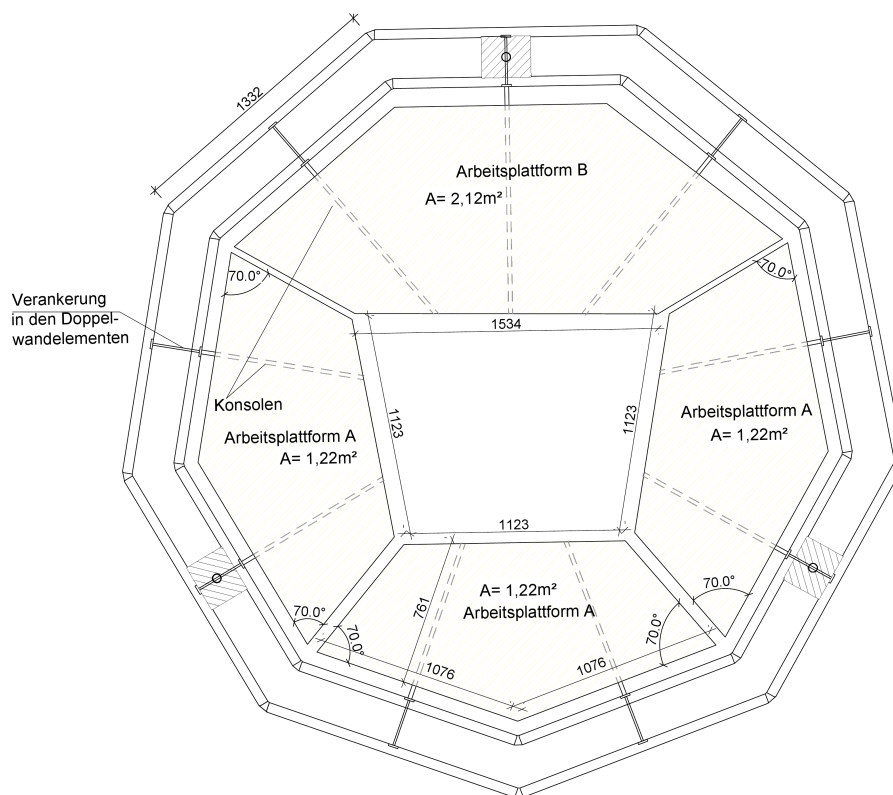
Gerüstbühnen im Grundriss des Segment 1
